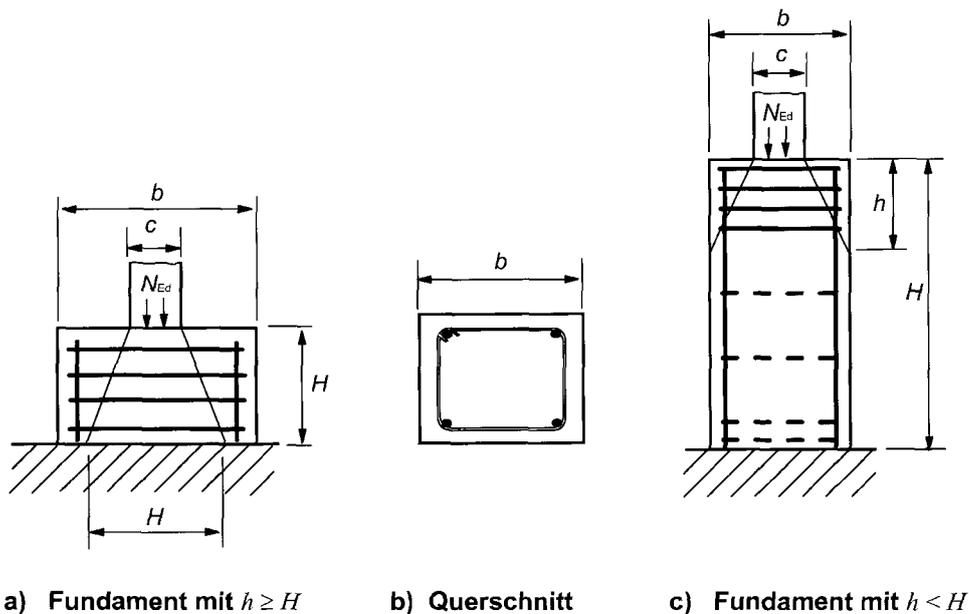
Spaltbewehrung bei Einzelfundamenten auf Fels
